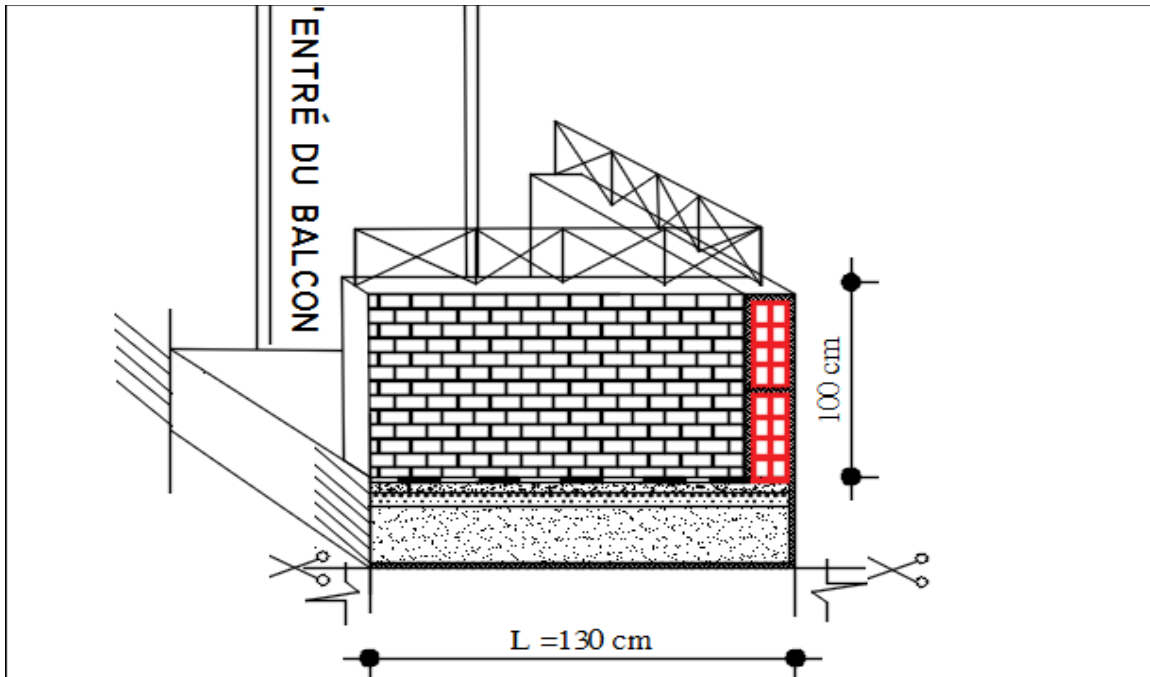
Coupe transversal du plancher dalle plein (balcon).
